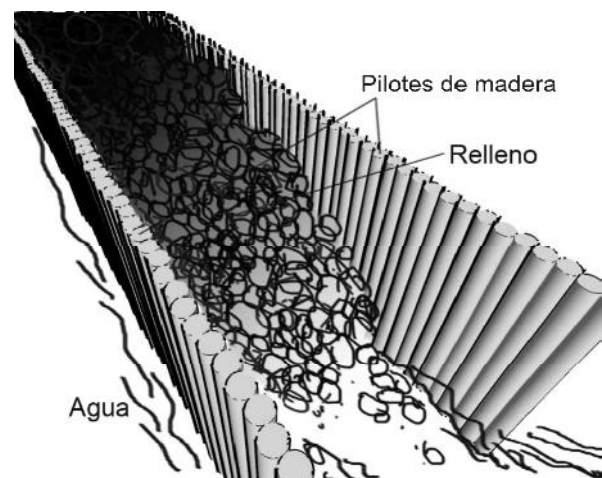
Avenidas aztecas con pilotes de madera.
